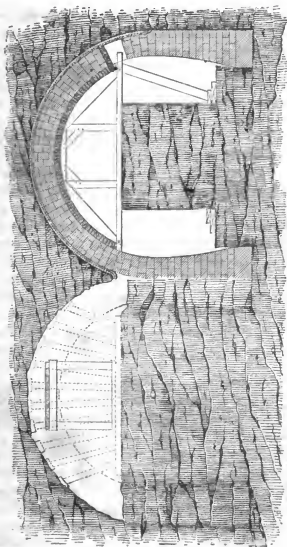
Percement et muraillement du double souterrain des Bâtignolles.
